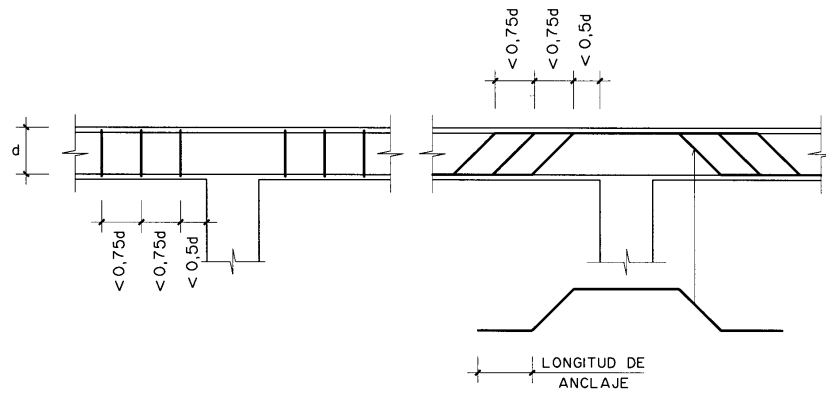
Disposición de armadura de punzonamiento, según la Instrucción EHE.
